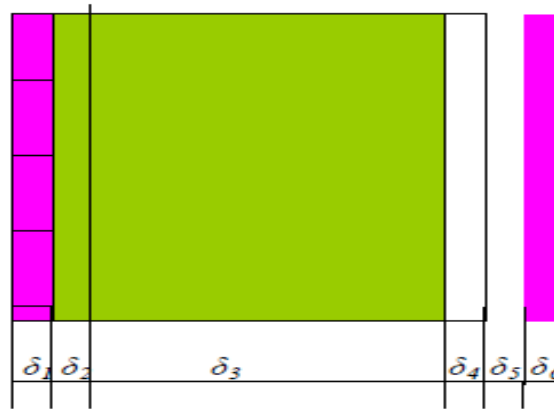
Схема поперечного перерізу зовнішньої стіни:
